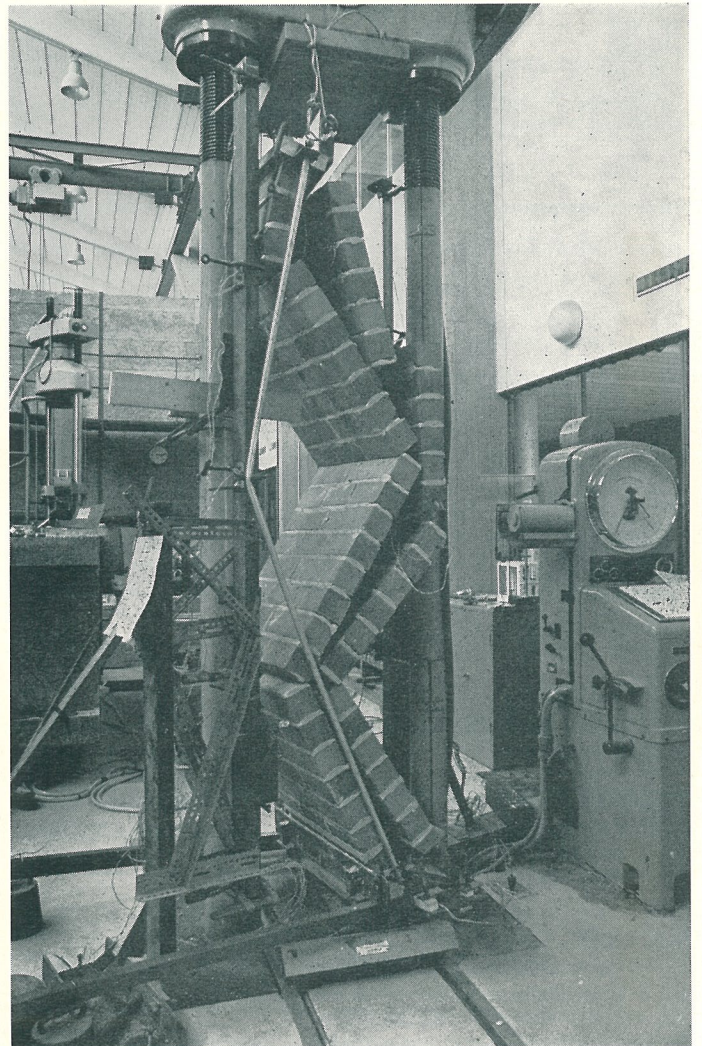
En F-vägg efter stabilitetsbrott. An F-wall after failure due to instability.
